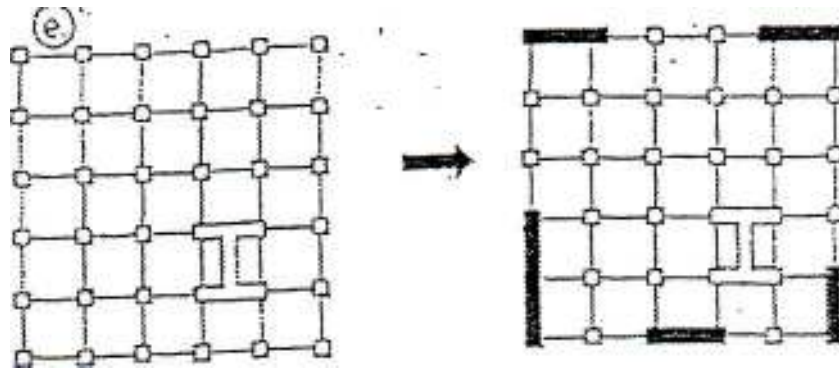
b Yeni Perde Eklemek Suretiyle Burulma Mukavemetinin Arttırılması
